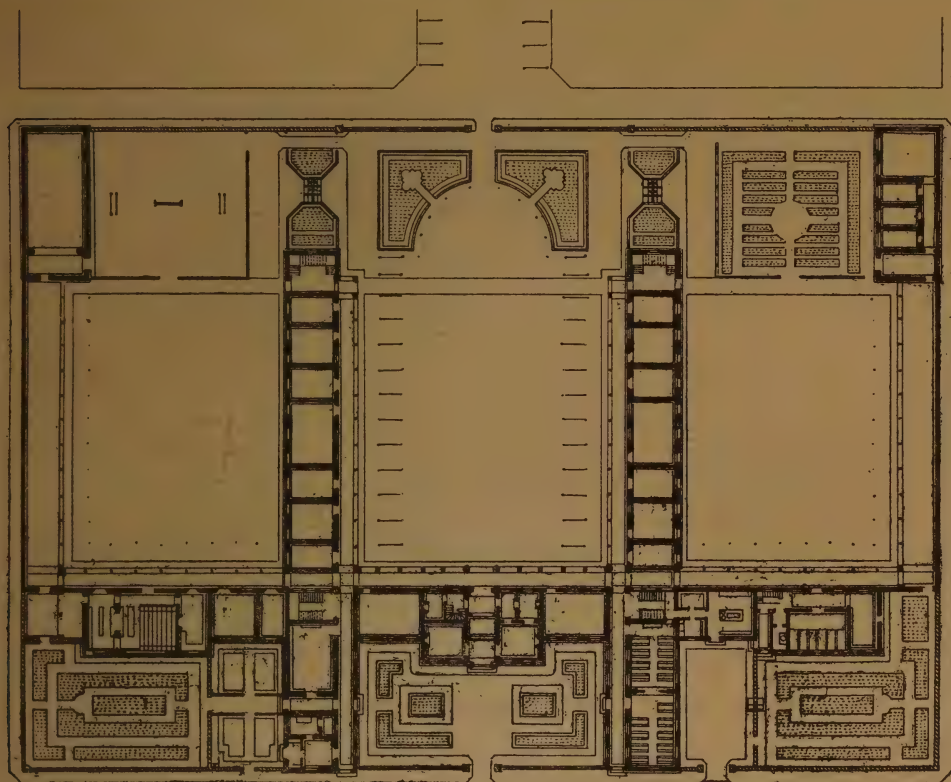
Collège Carnot, à Fontainebleau, plan du rez-de-chaussée.
